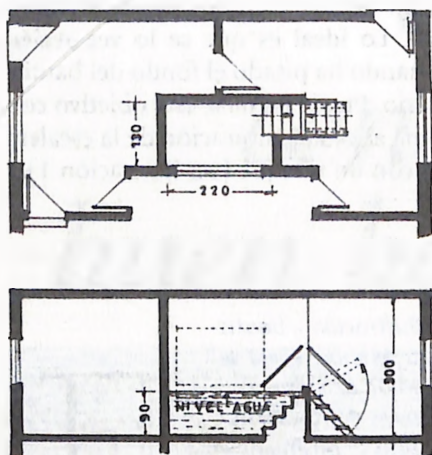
Bautisterio con una sola escalera de acceso y escalera exterior levadiza. El piso del bautisterio está al mismo nivel que el piso de la plataforma y del vestuario.
